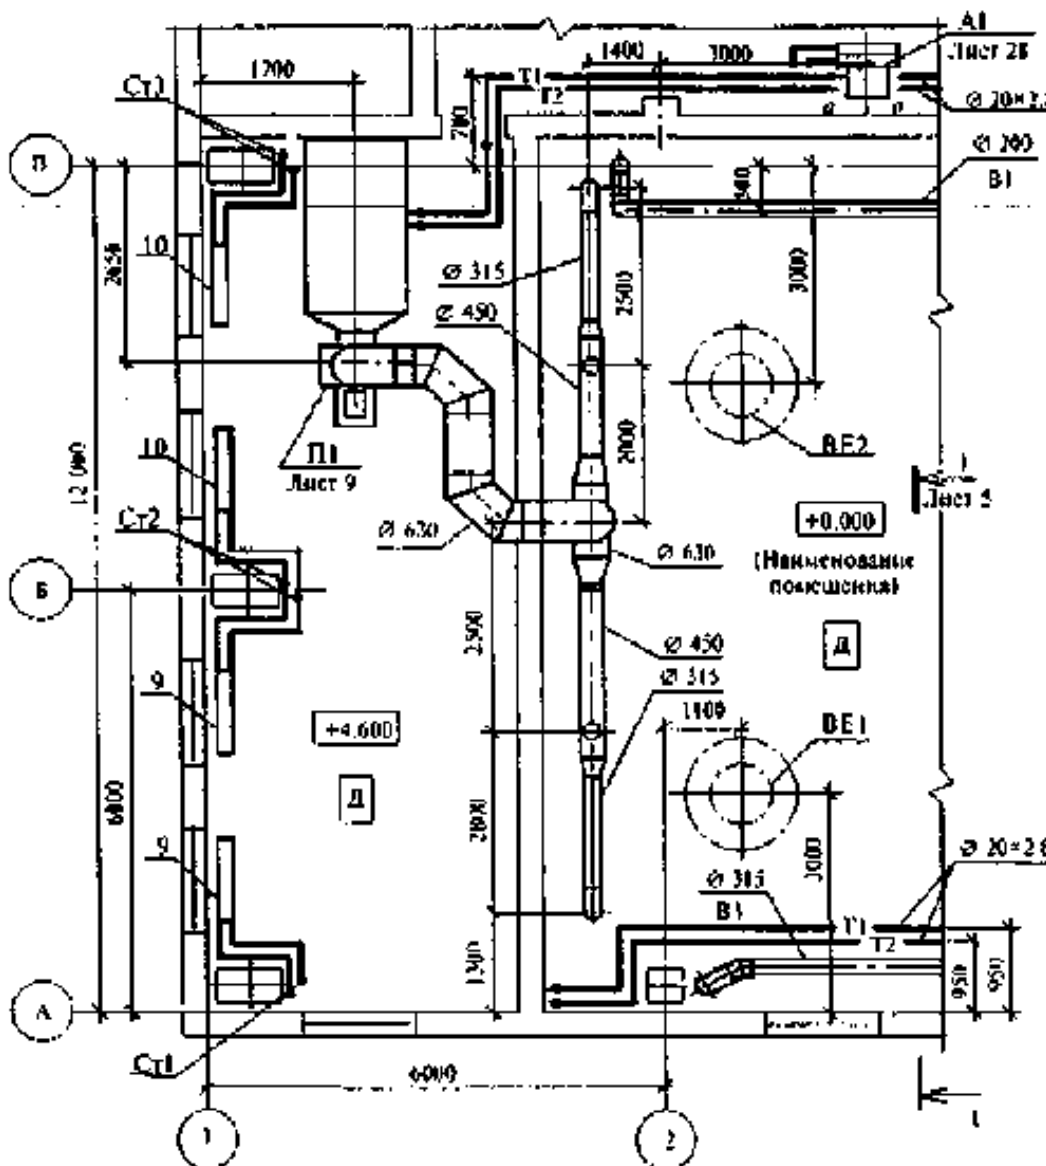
Пример выполнения плана систем отопления и вентиляции
